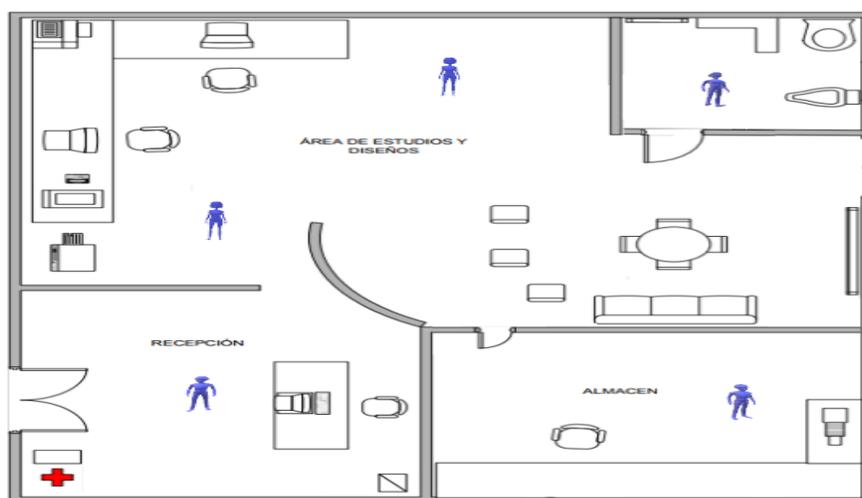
Layout - distribución de la oficina fuente: elaboración propia
